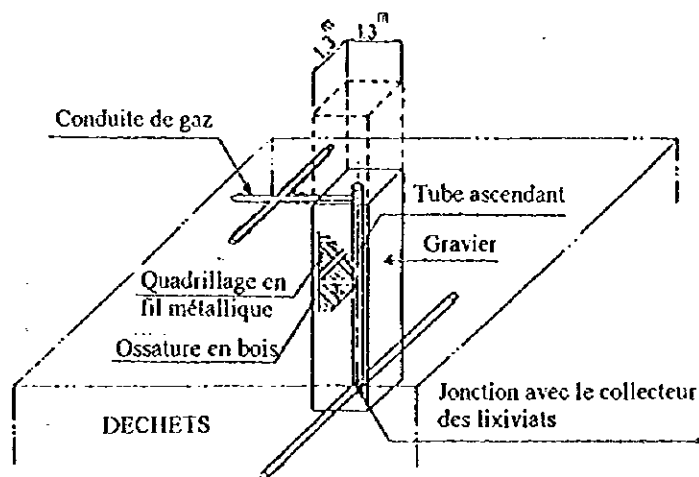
| Installations typiques de la décharge de Bettioua (1/3)
